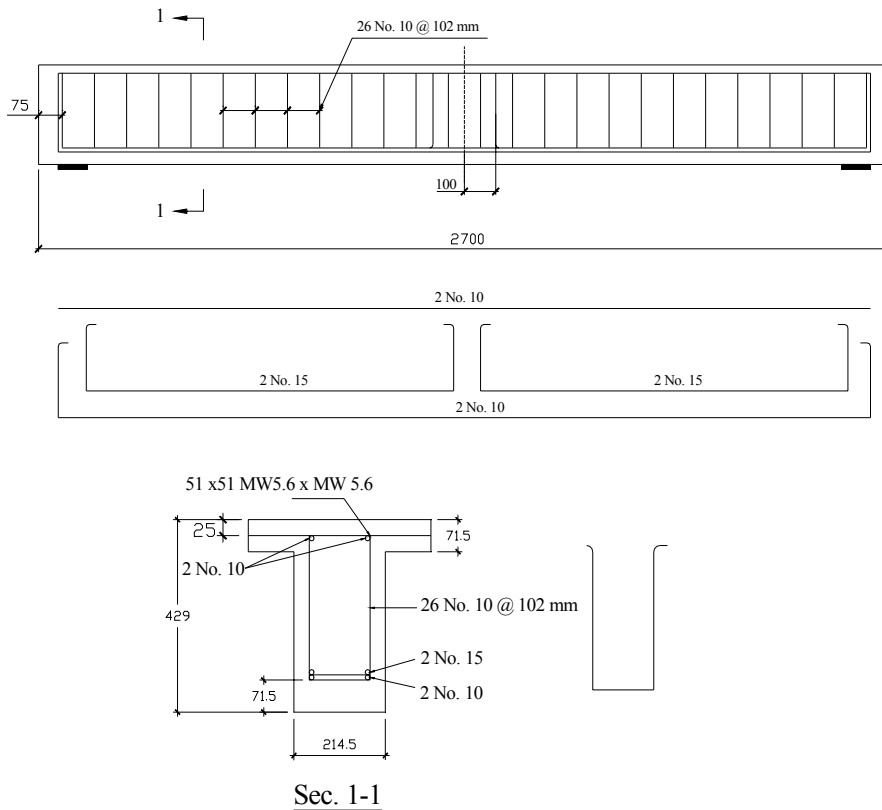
Detalhe da armação da vigas (Hassan, 2002)
